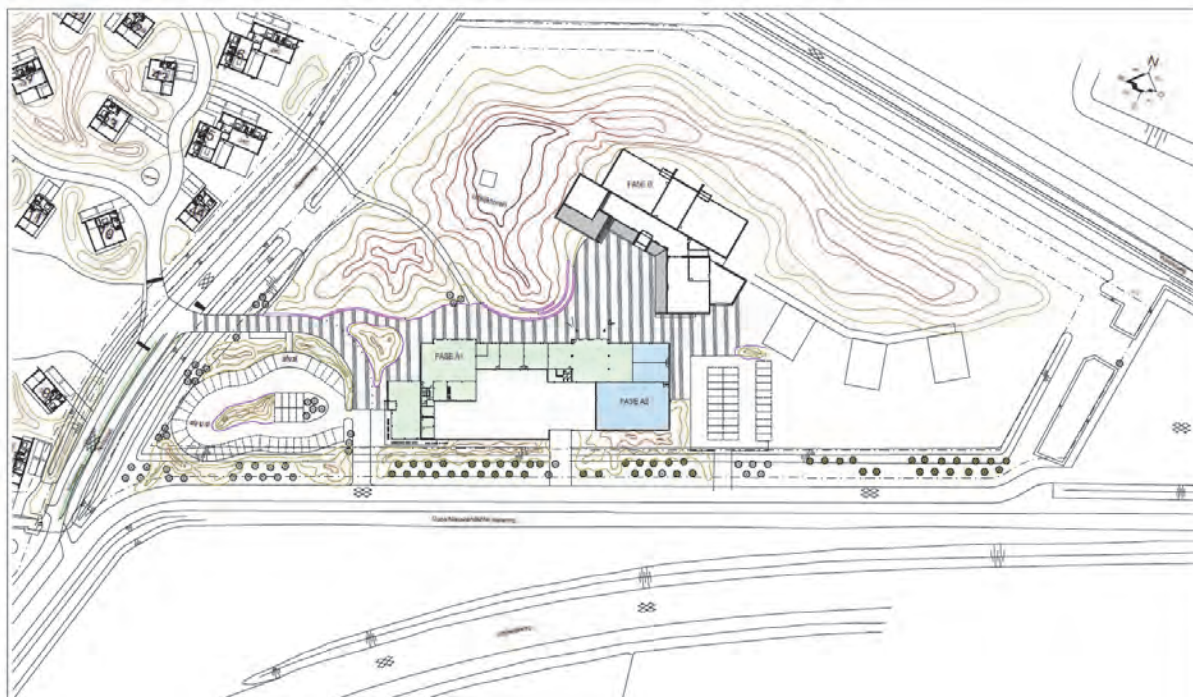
Oostrand plangebied, kijkrichting NO.
